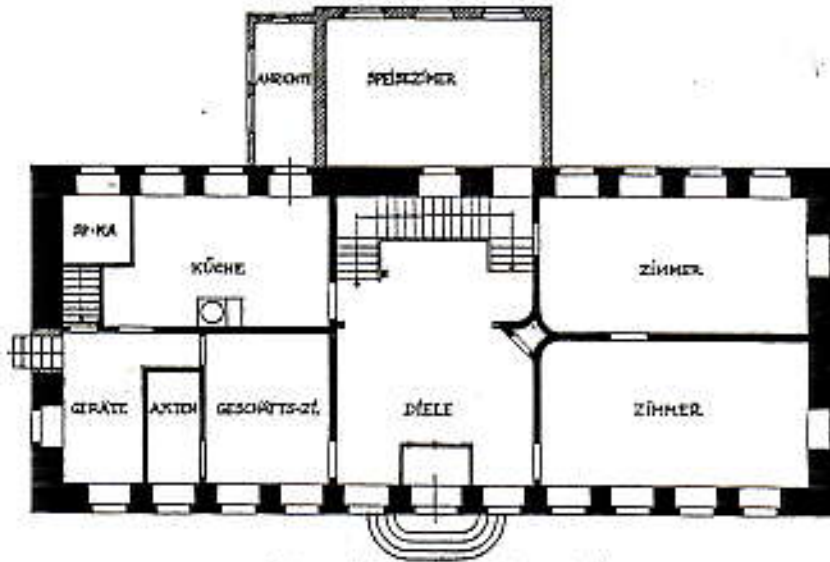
Pächterwohnhaus der Domäne Winzenburg; Grundriß des Erdgeschosses. (1:250.)
